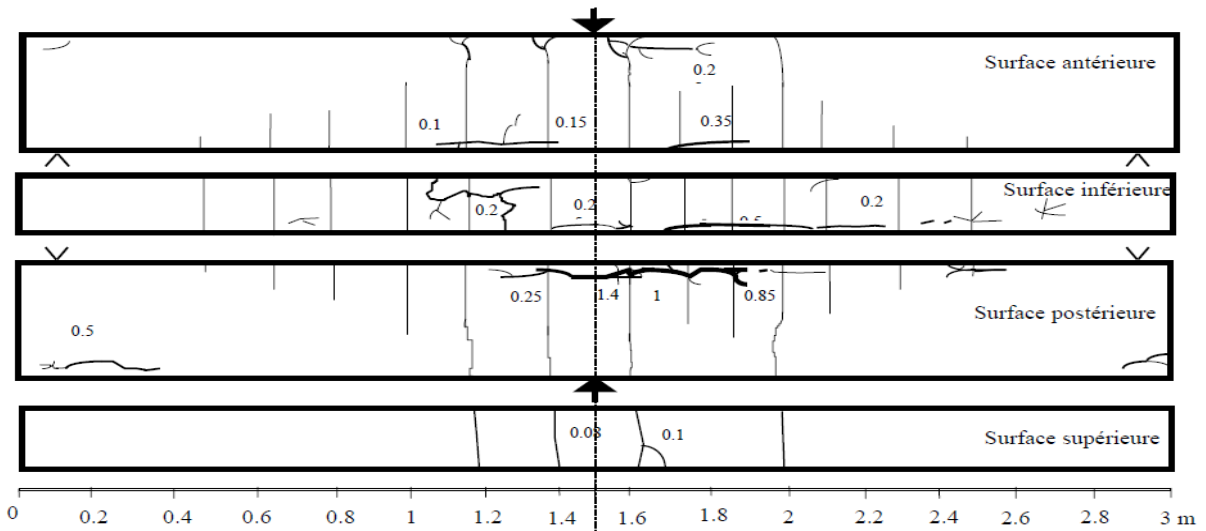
Carte de fissuration de la poutre B1CL1 (ouverture des fissures en mm) après 14 ans (Vidal et al. 2007).
